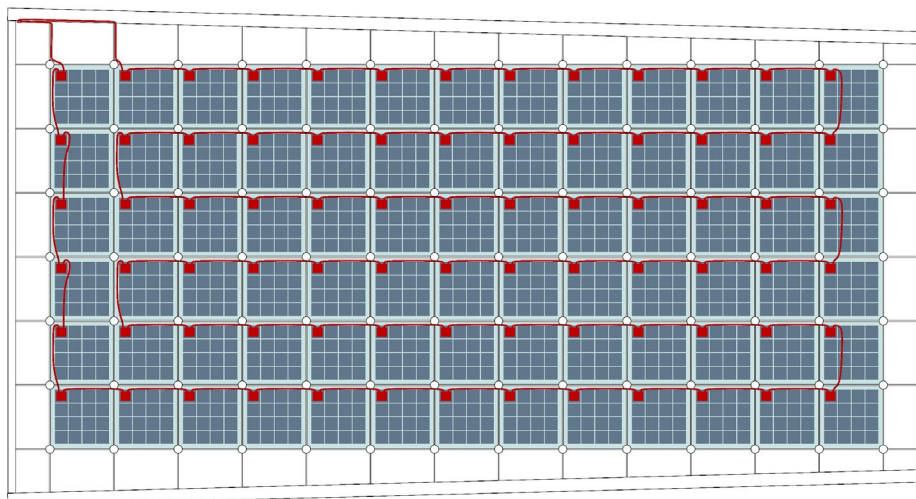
Vista inferior de la cubierta según la primera configuración.
